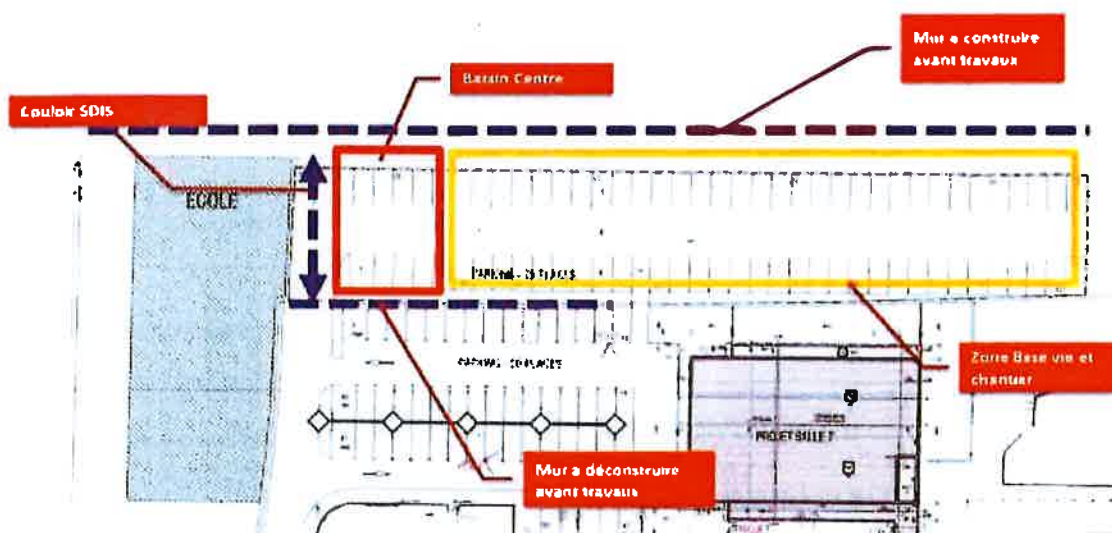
BSR Centre – Travaux préalables et zone chantier
